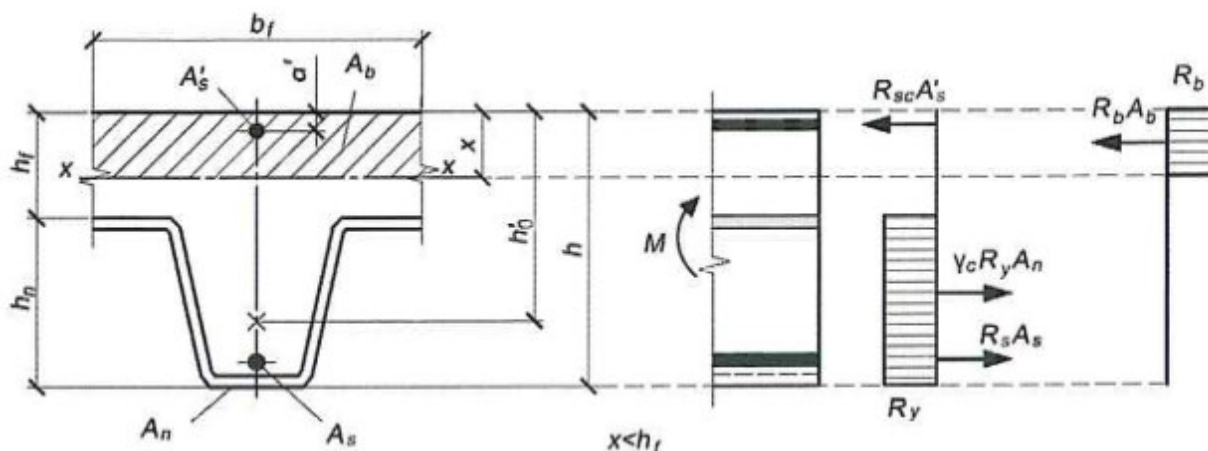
Схема работы перекрытия в пролетной зоне
